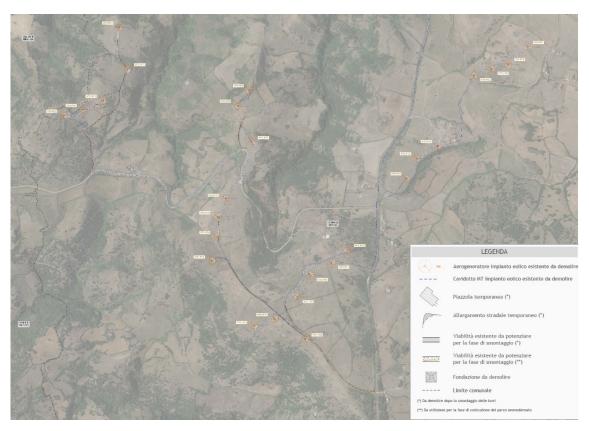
Stralcio della planimetria con individuazione dell'impianto eolico esistente su ortofoto
